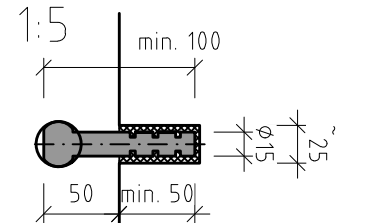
DETAIL B. MĚŘENÍ ÚČINKŮ BLUDNÝCH PROUDŮ
